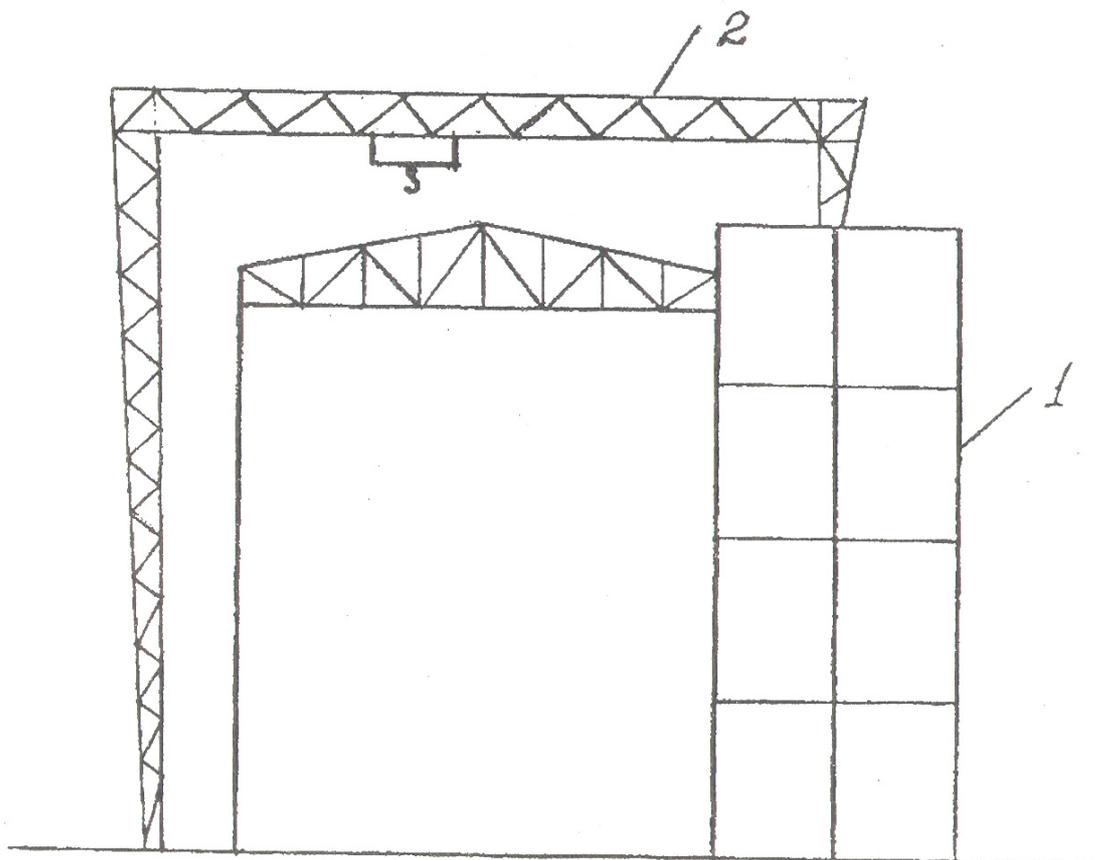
Использование козловых кранов: 1 — железобетонные многоэтажные вставки; 2 — козловой кран
